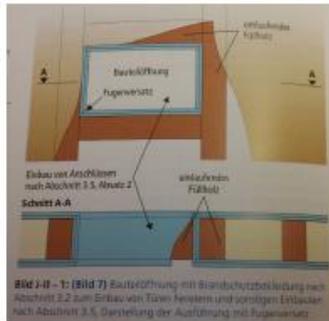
B - 1: (Bild 7) Schnittöffnung mit Brandschutzbelegung nach Abschnitt 3.2 zum Einbau von Türen, Fenstern und sonstigen Einbauten nach Abschnitt 3.5, Darstellung der Ausführung mit Fugenbreiten
